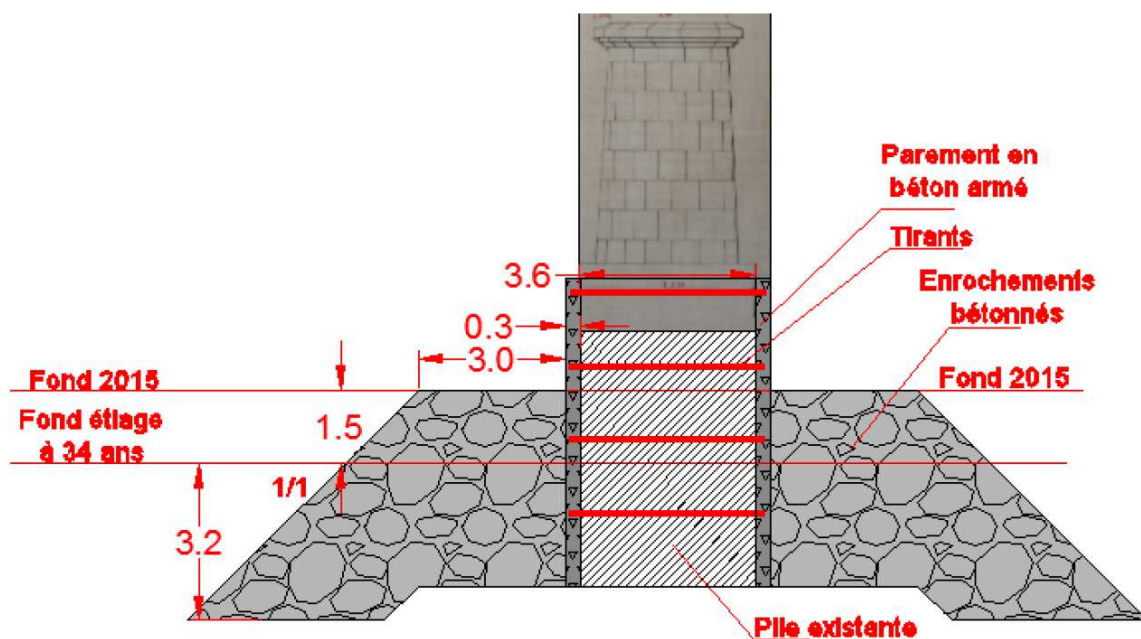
Profil en travers du confortement des piles du pont des CFP
